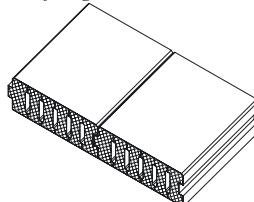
Strop z betonskimi rebri, opečnimi polnili in tlačno ploščo.
